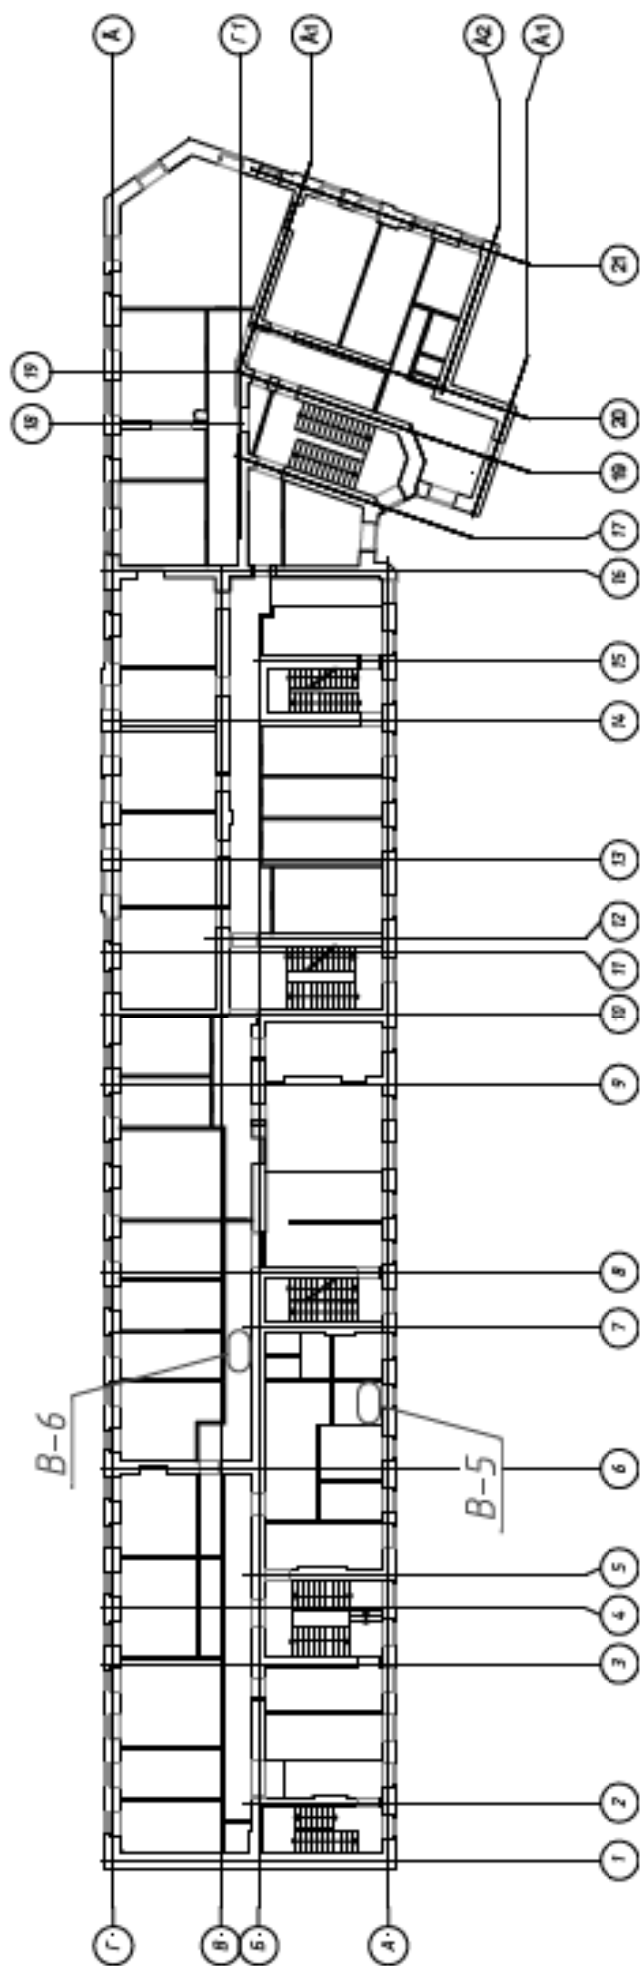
Схема расположения вварыгний 3-го этажа
